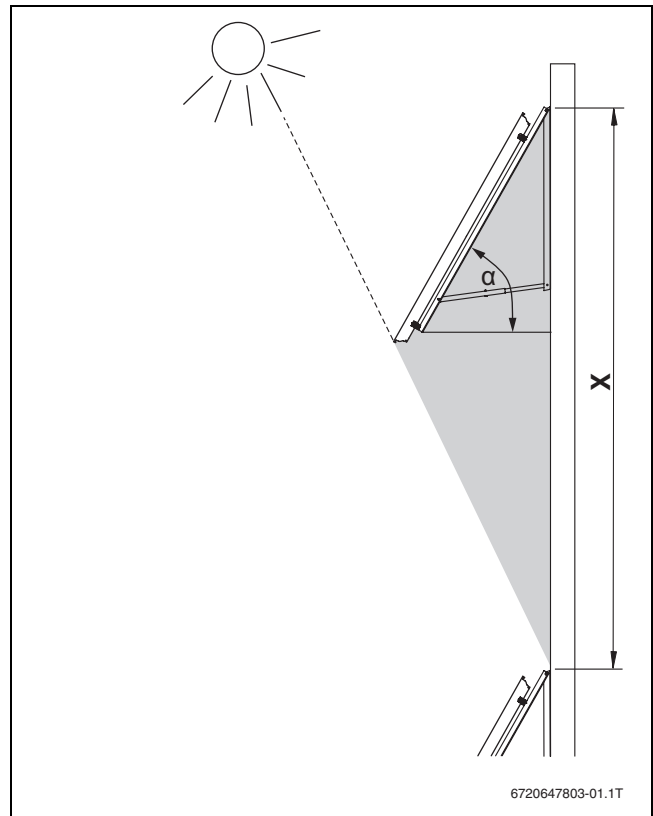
Расстояние между рядами и затенение при монтаже на фасаде
